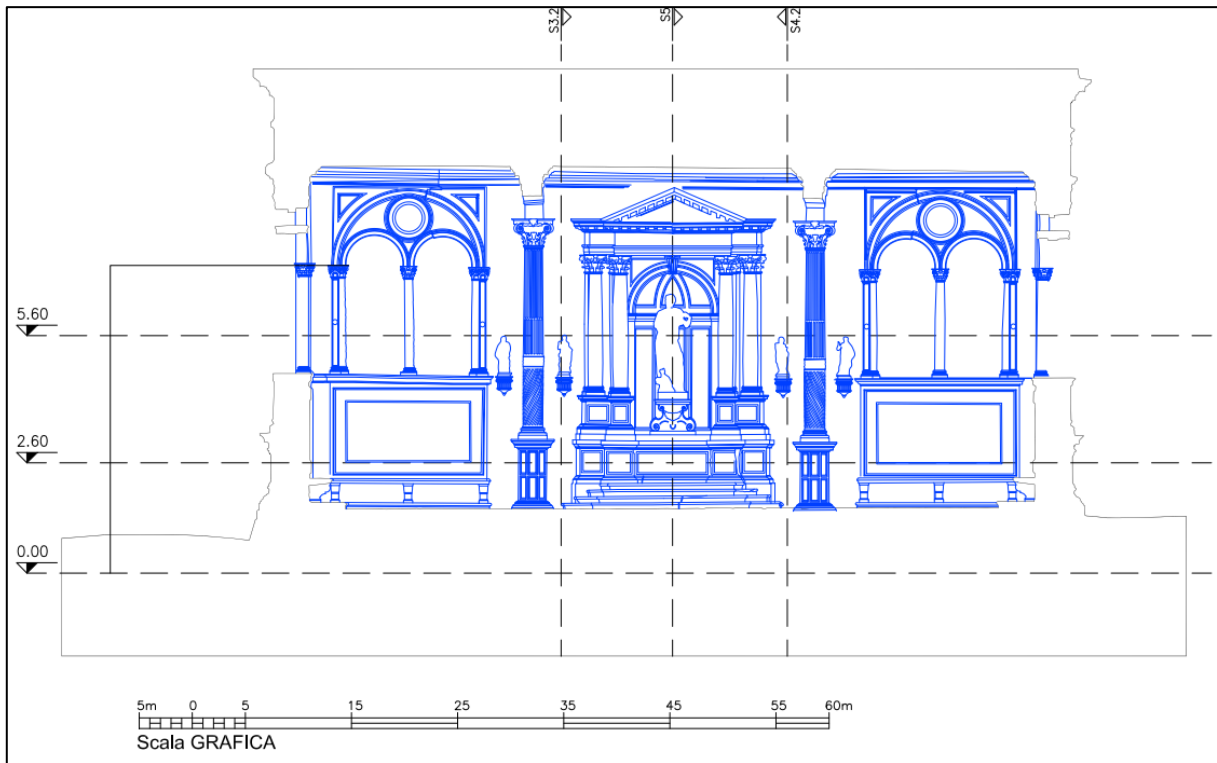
Sezione 1 – sezione verticale e vista prospettica
